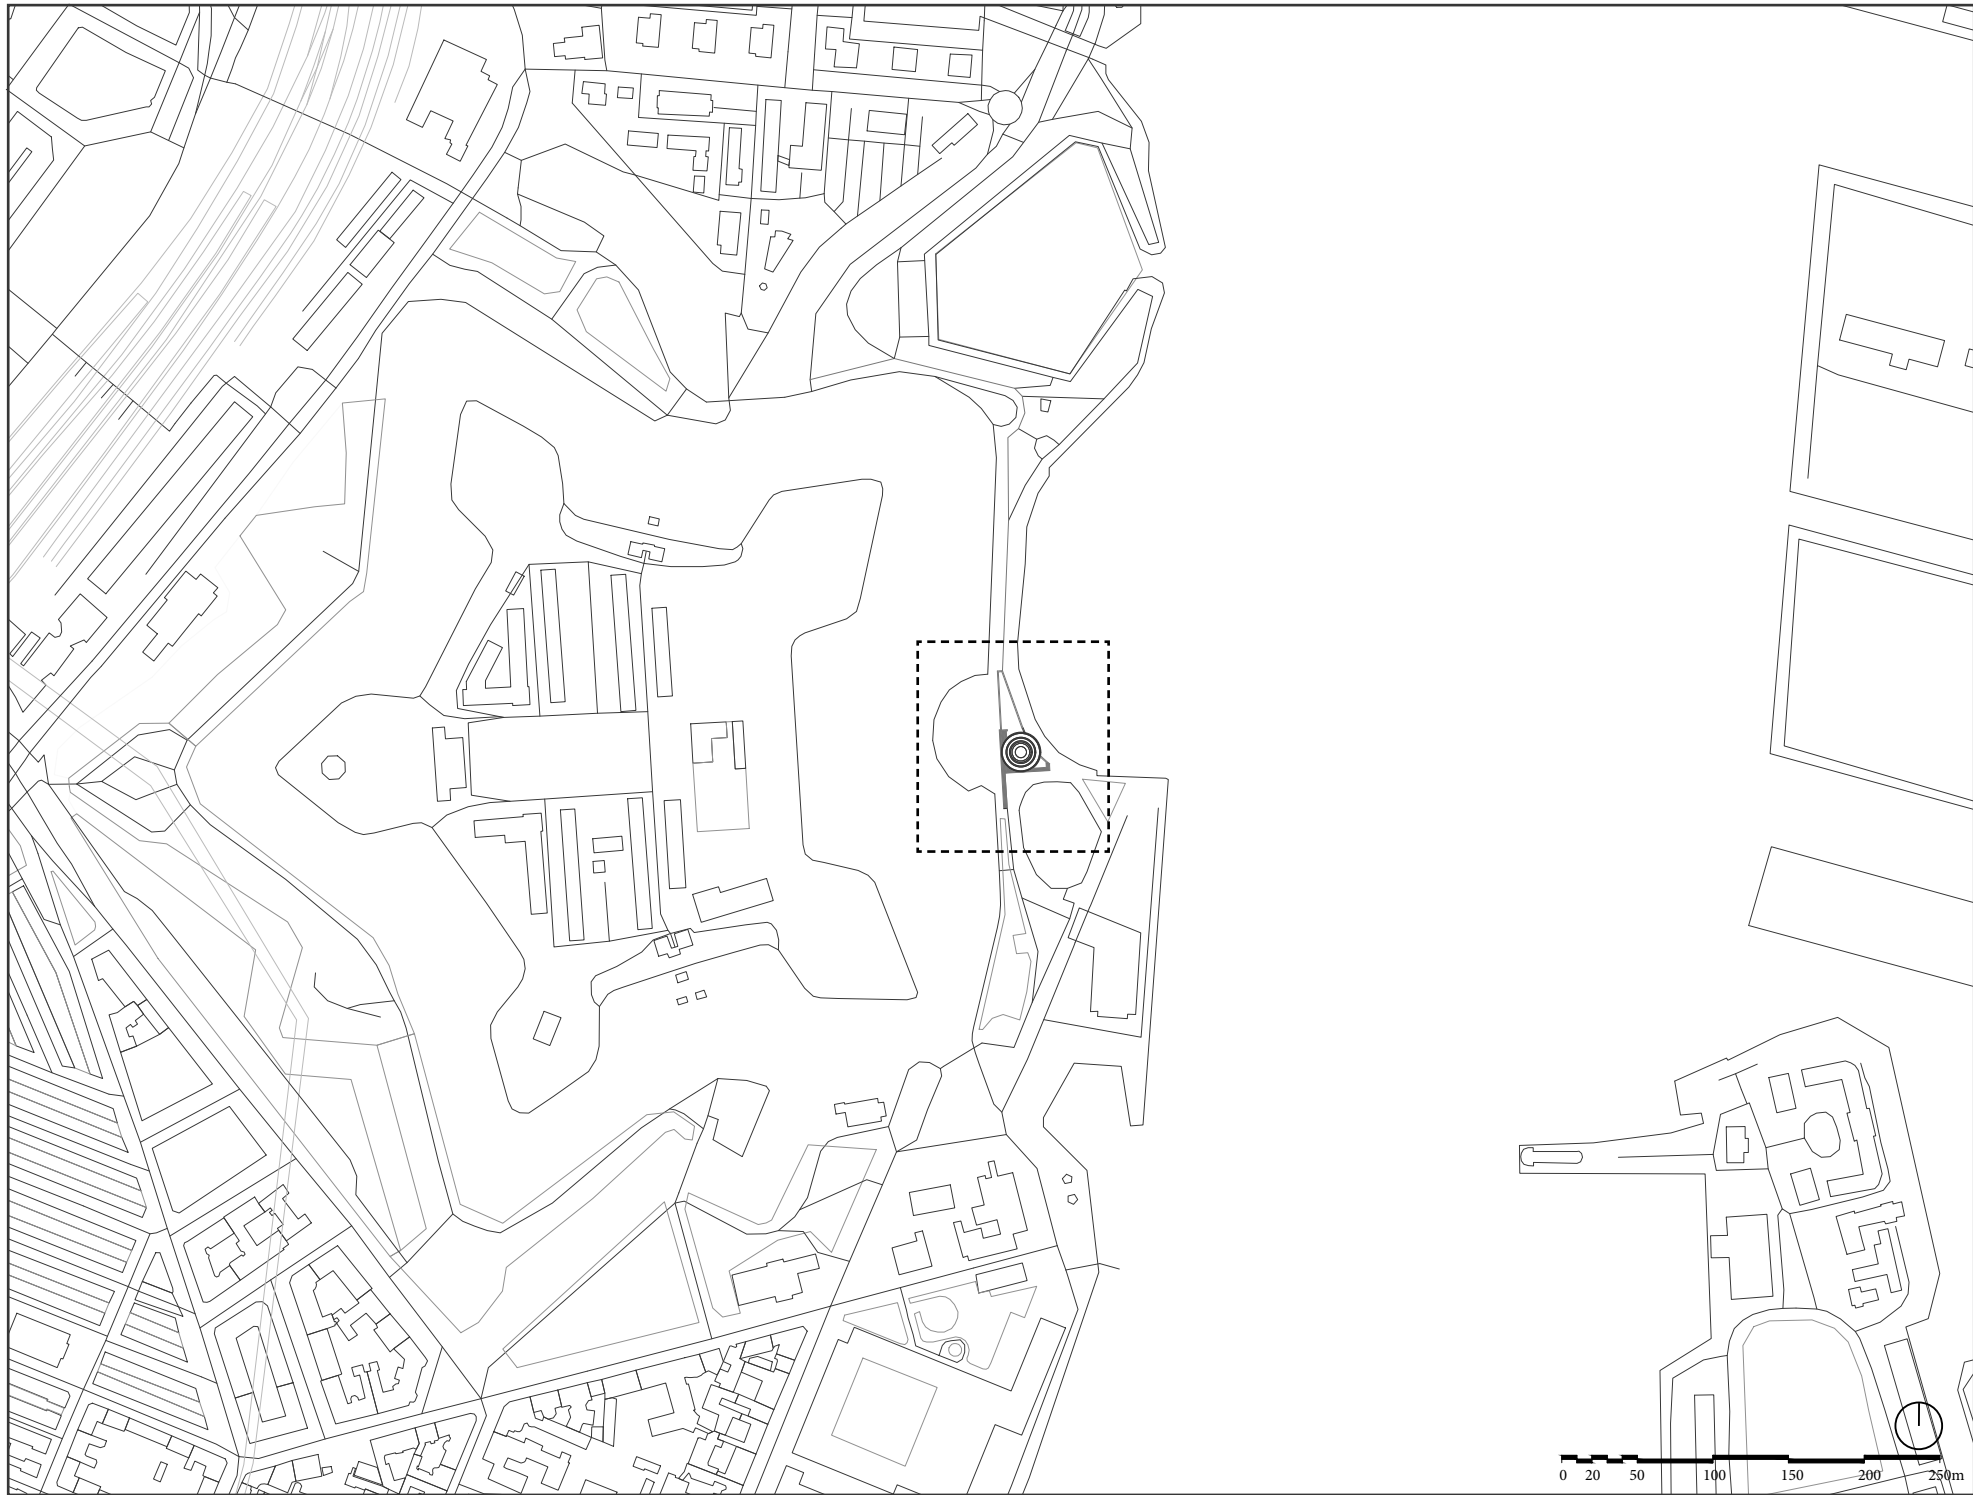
Plano Situación. Ciudad de Copenhague. [Fuente: Autor]
